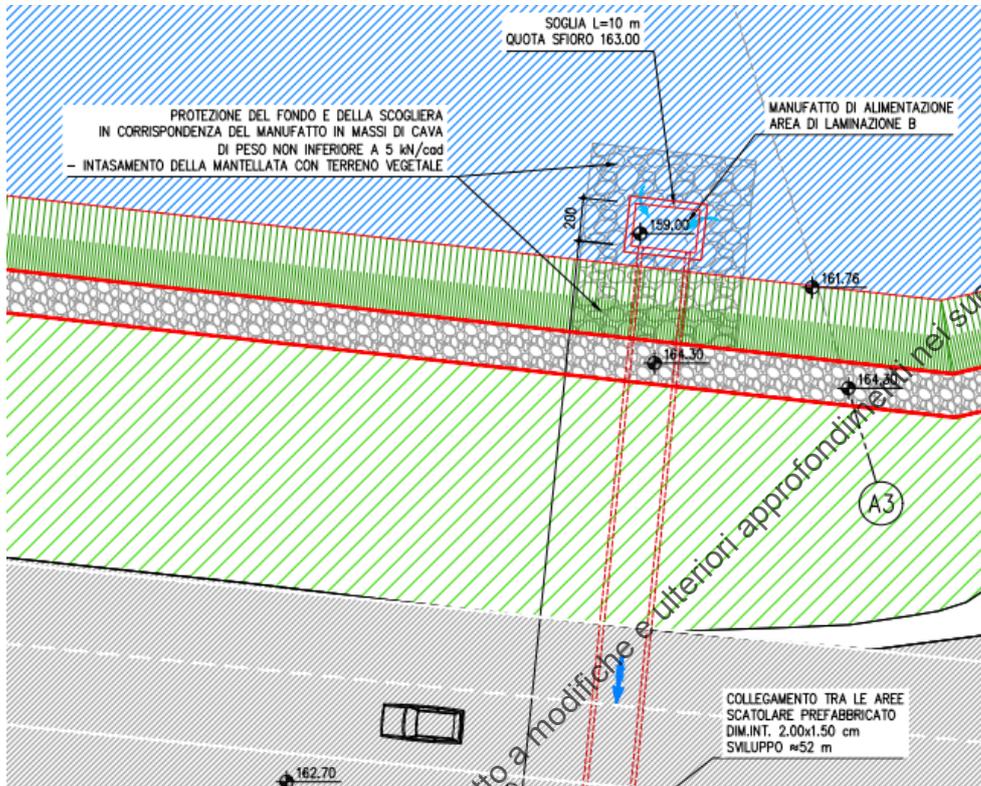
imbocco dell'alimentazione dell'area di laminazione B. Estratto da Tav. 13.1
